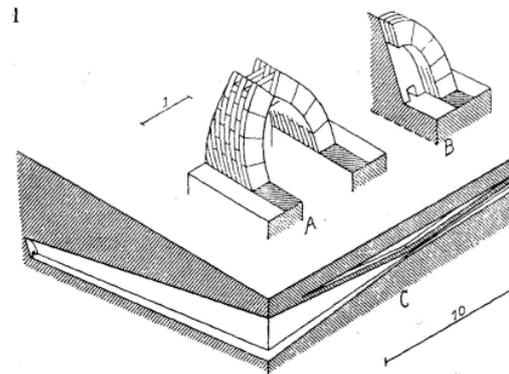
Bóvedas construidas sin cimbra de una galería subterránea de Khorsabad. (Fuente: Auguste Choisy, *Histoire de l'architecture*, t1. p.90. 1899).
